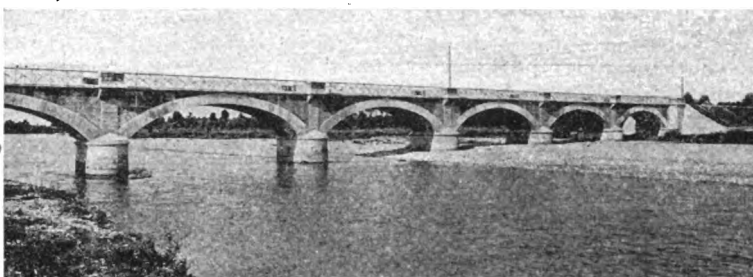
Ponte sul fiume Oglio visto di prospetto.
